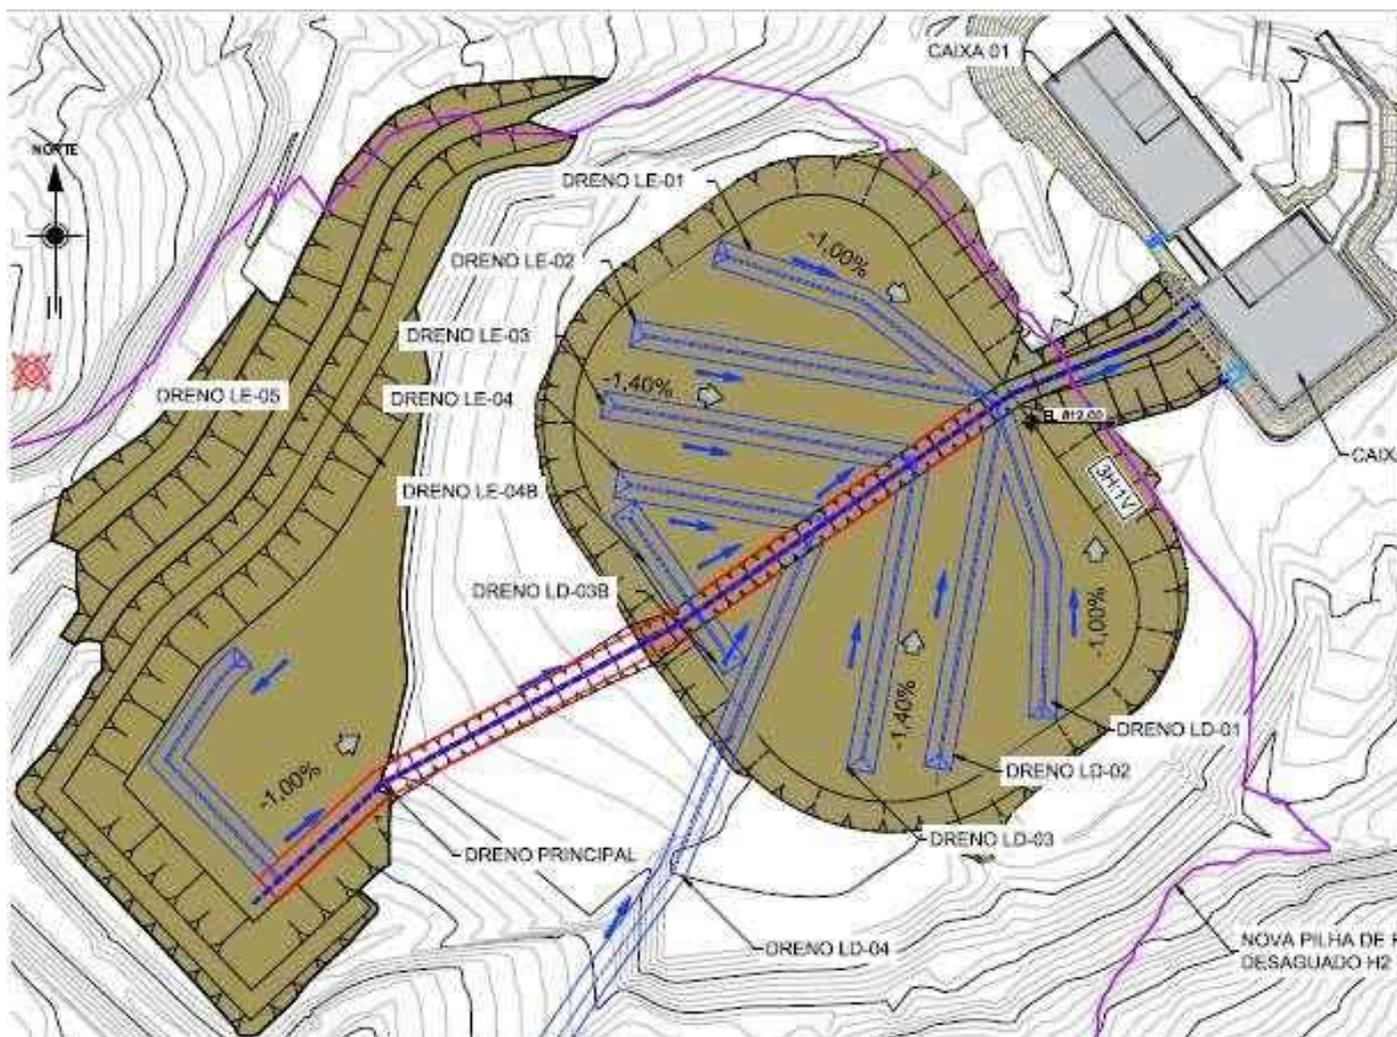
Planta esquemática do dreno de condução das águas subterrâneas
